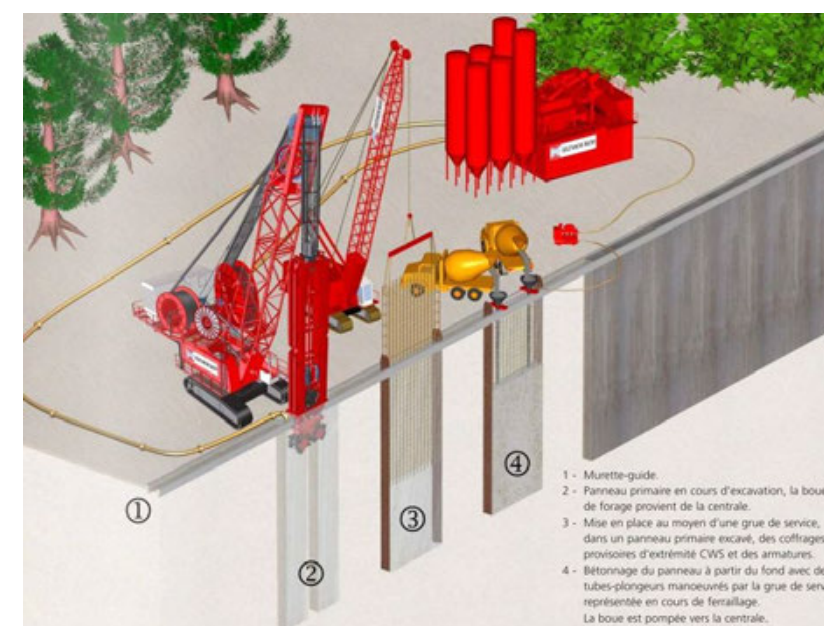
Exécution d'une paroi moulée (Source : Soletanche Bachy)
